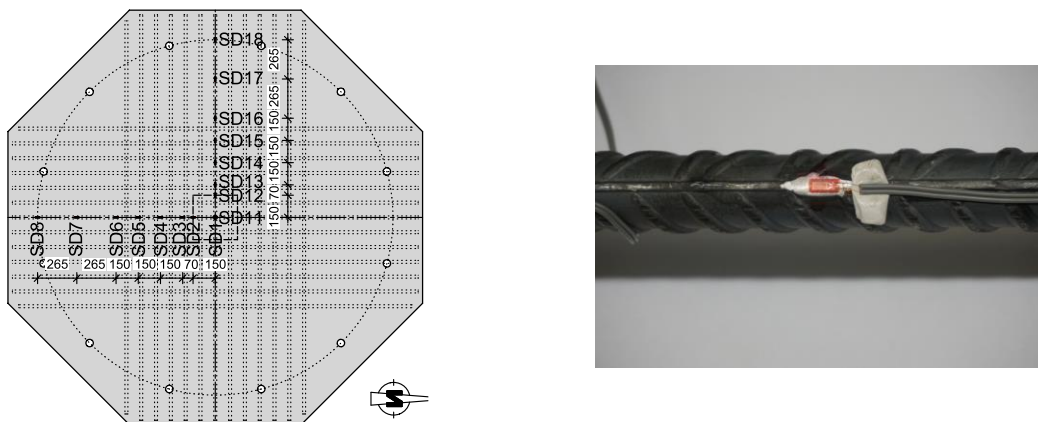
Übersicht Anordnung der Betonstahl-DMS (links) und Detail eines Betonstahl-DMS (rechts) [42]
